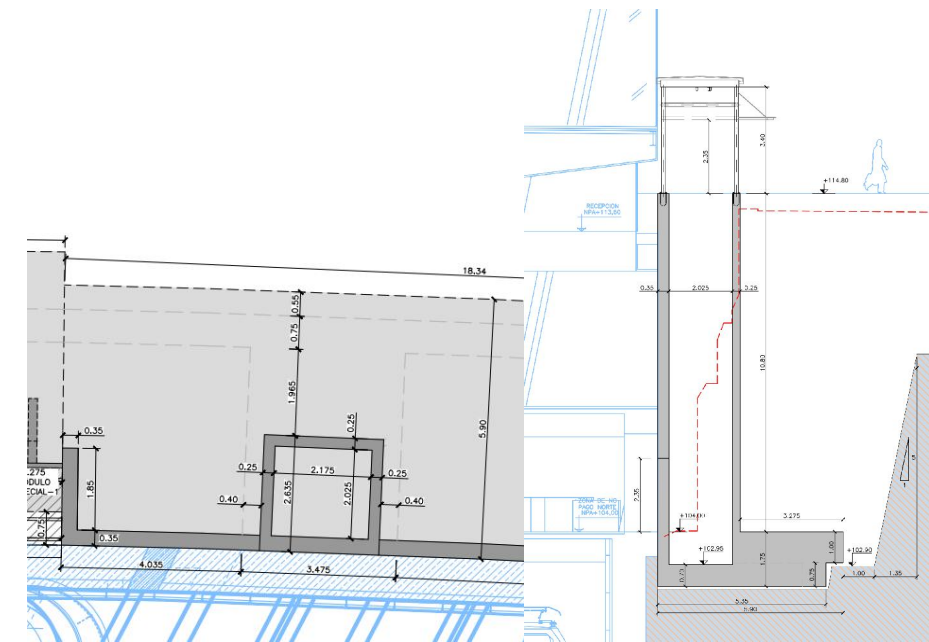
Posición en planta y alzado del ascensor junto mezzanina.
